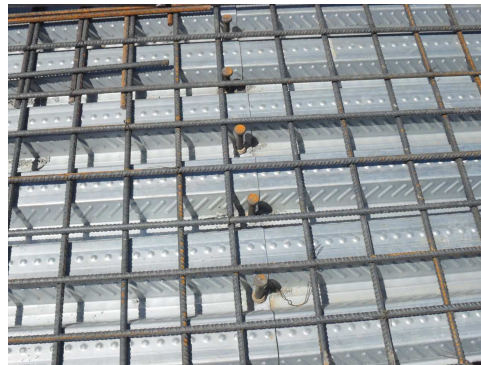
Colocação da armadura de distribuição na laje colaborante
